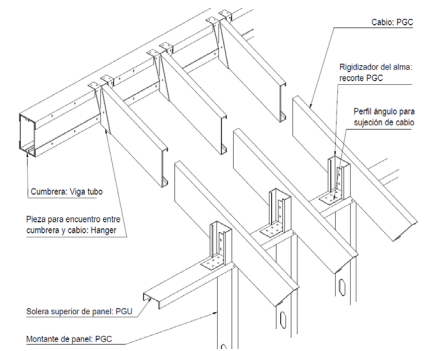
Viga tubo en la cumbrera para apoyar las vigas.
